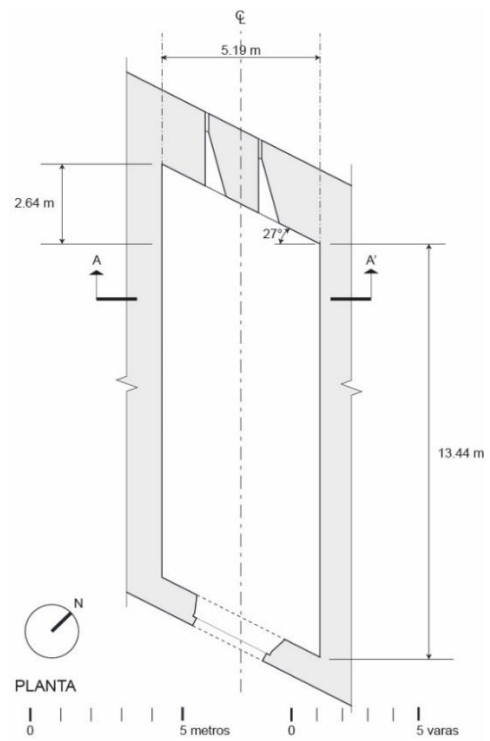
53 Planta arquitectónica que se cubre con la bóveda B-04.
